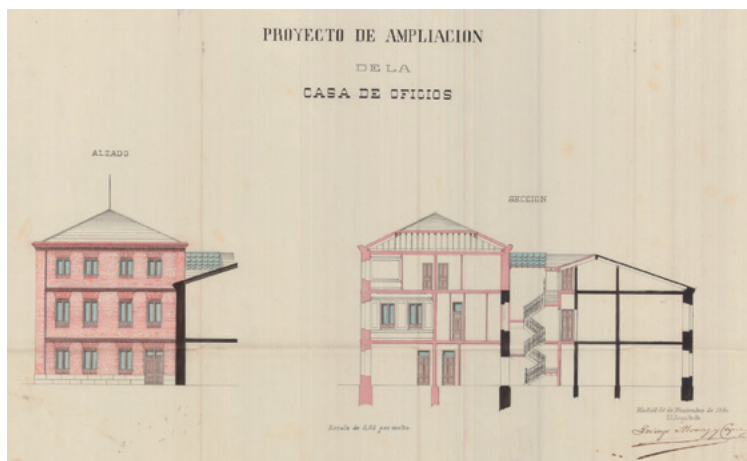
Proyecto de ampliación de la Casa de Oficios. Alzado y sección. Lorenzo Álvarez y Capra, 1880. Fuente: AGA, Fondo Ministerio de Educación, IDD (05)001.025, Caja 31/08133.
